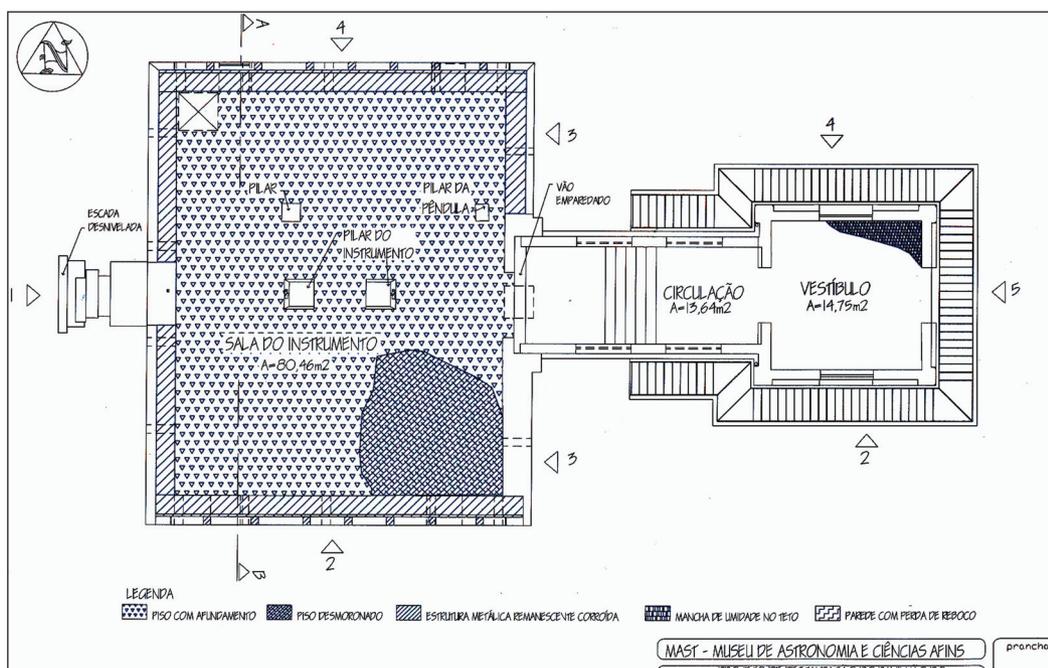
Planta baixa. Desenho com mapeamento de danos no pavilhão da luneta meridiana de Gautier. Arquivo MAST, Rio de Janeiro.
